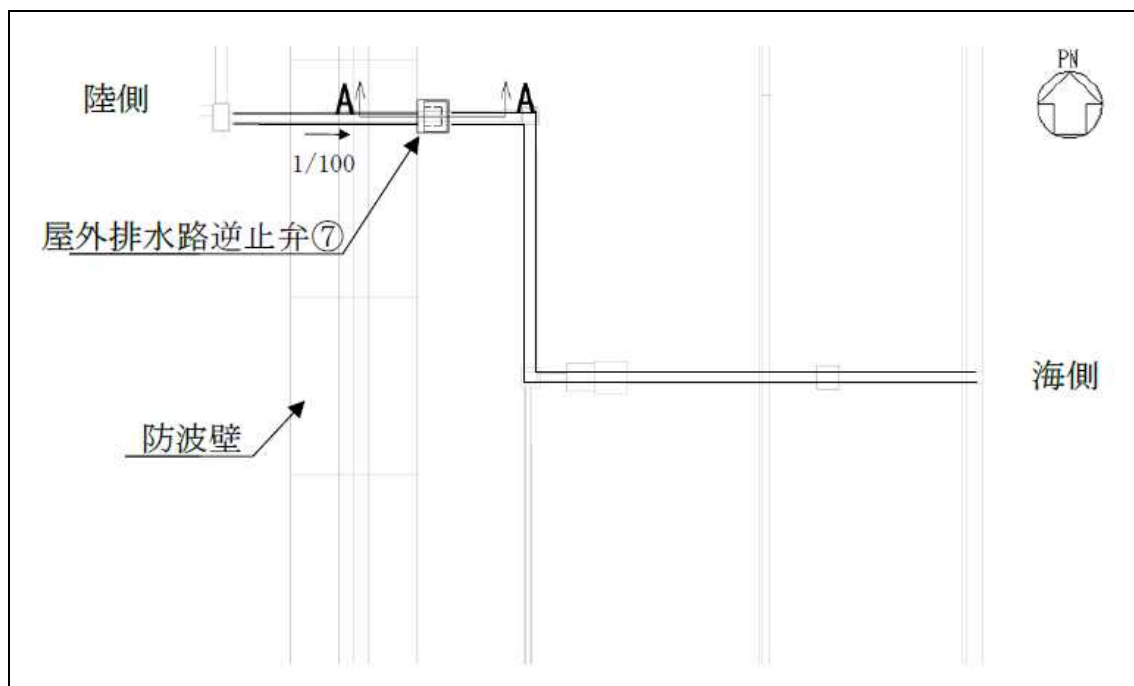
屋外排水路逆止弁の配置例（平面図）（中国電力 島根 2 号炉）
